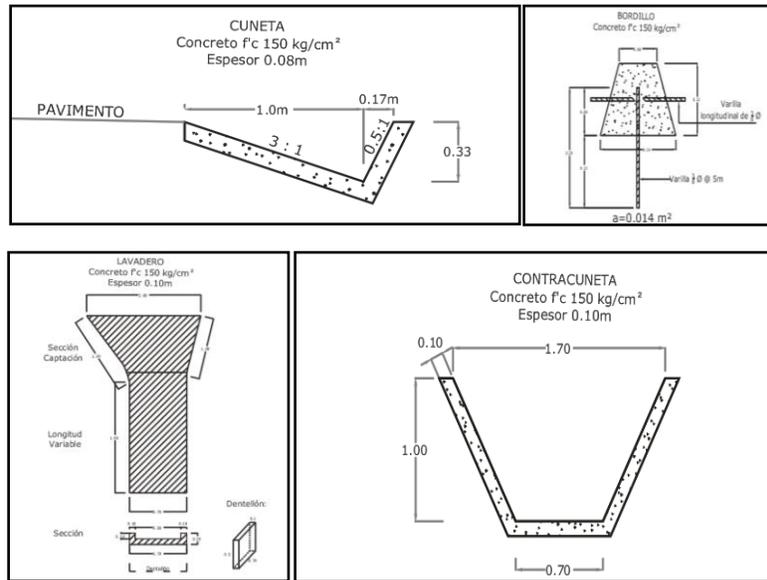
Sección tipo de las obras de drenaje complementarias.
